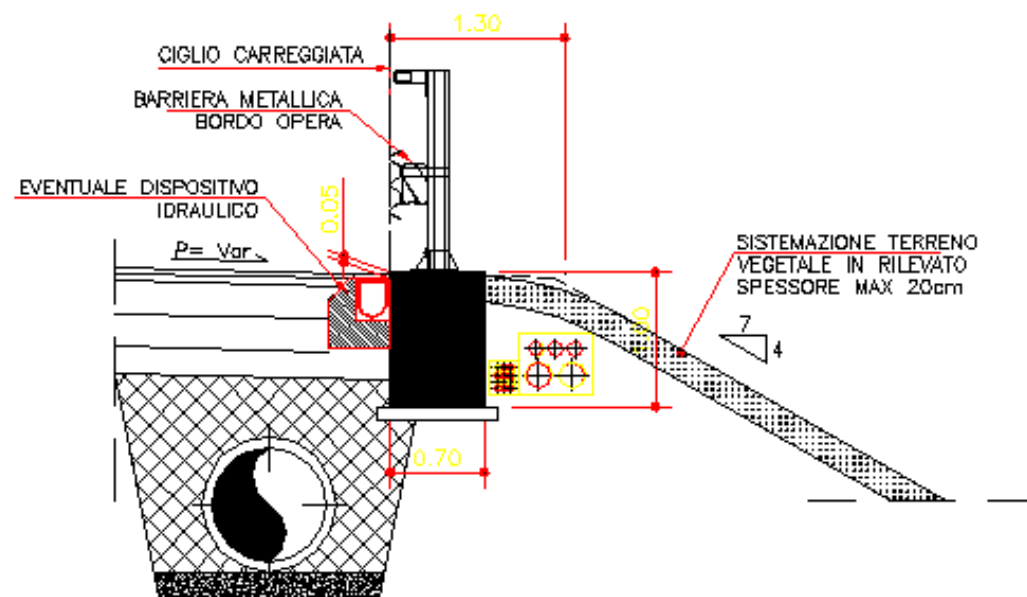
Sezione tipologica barriera metallica bordo opera d'arte di progetto (fonte: Progetto definitivo – Elaborati di dettaglio)
